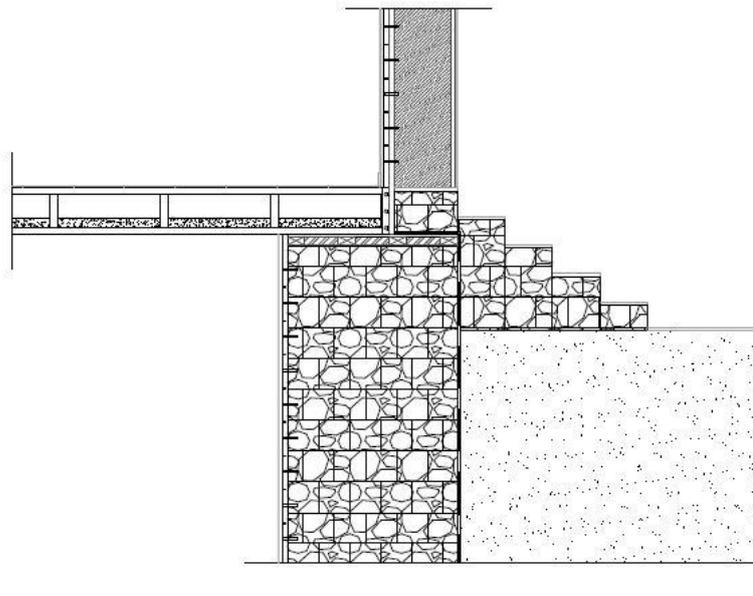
Unión de estructura con sobrecimentación. Fuente: Elaboración propia.
